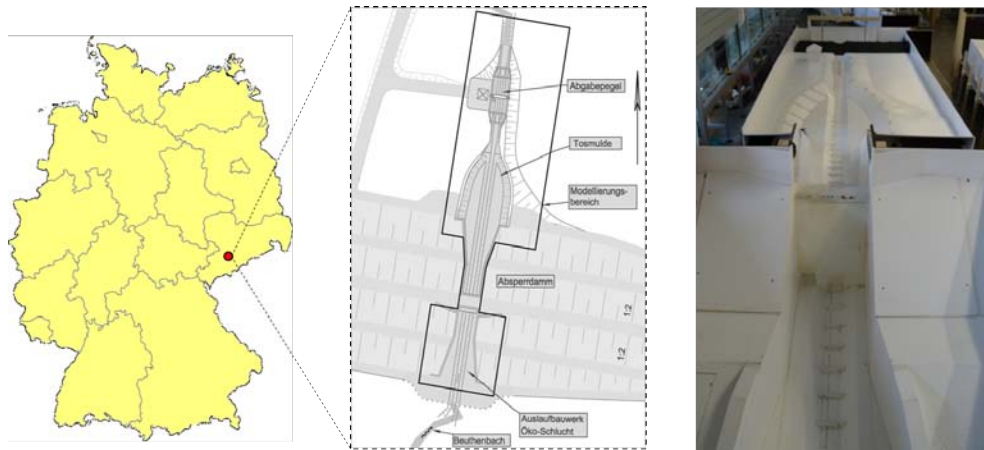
Lage (links), Grundriss Modellierungsbereich (mittig), Versuchsstand (rechts)
